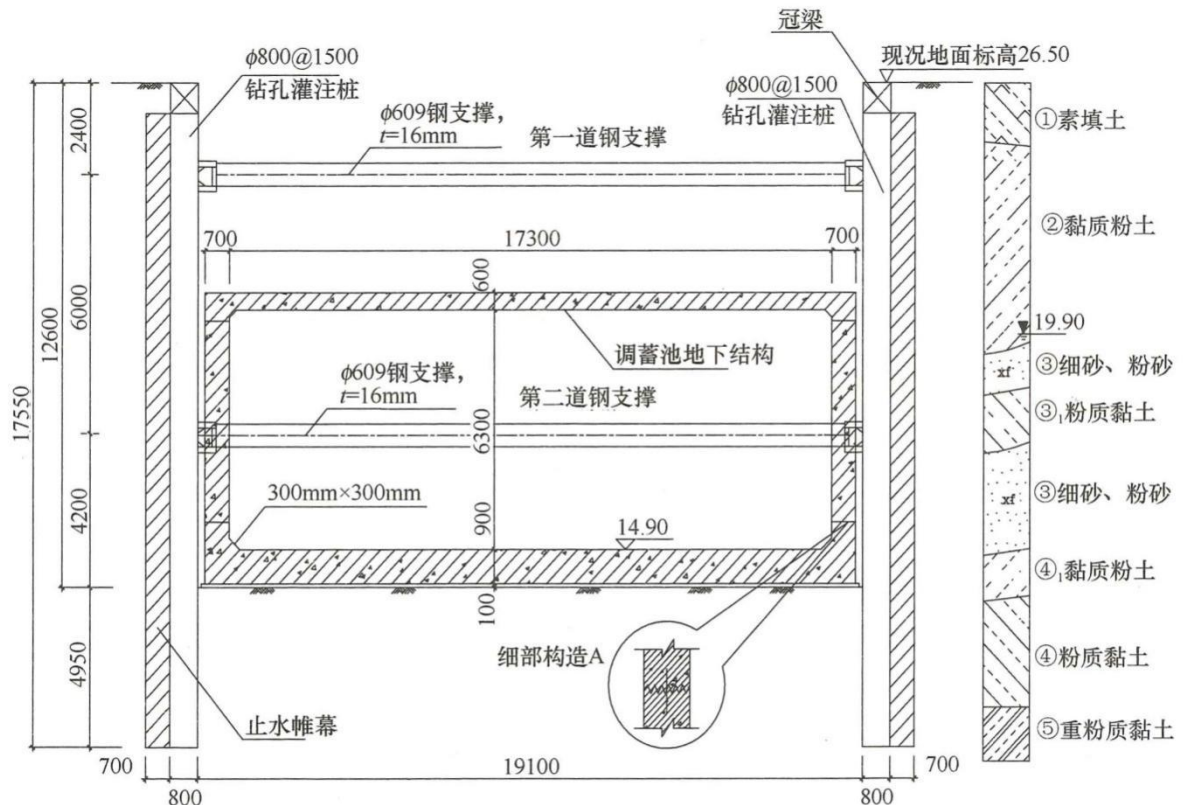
调蓄池结构与基坑围护断面图（单位：结构尺寸：mm，高程：m）
